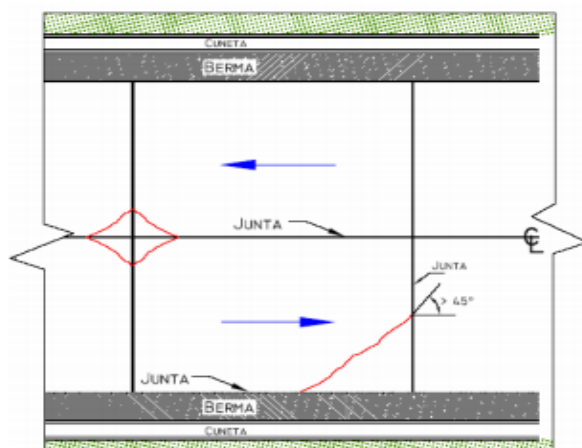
Vista en planta: Grieta de Esquina
